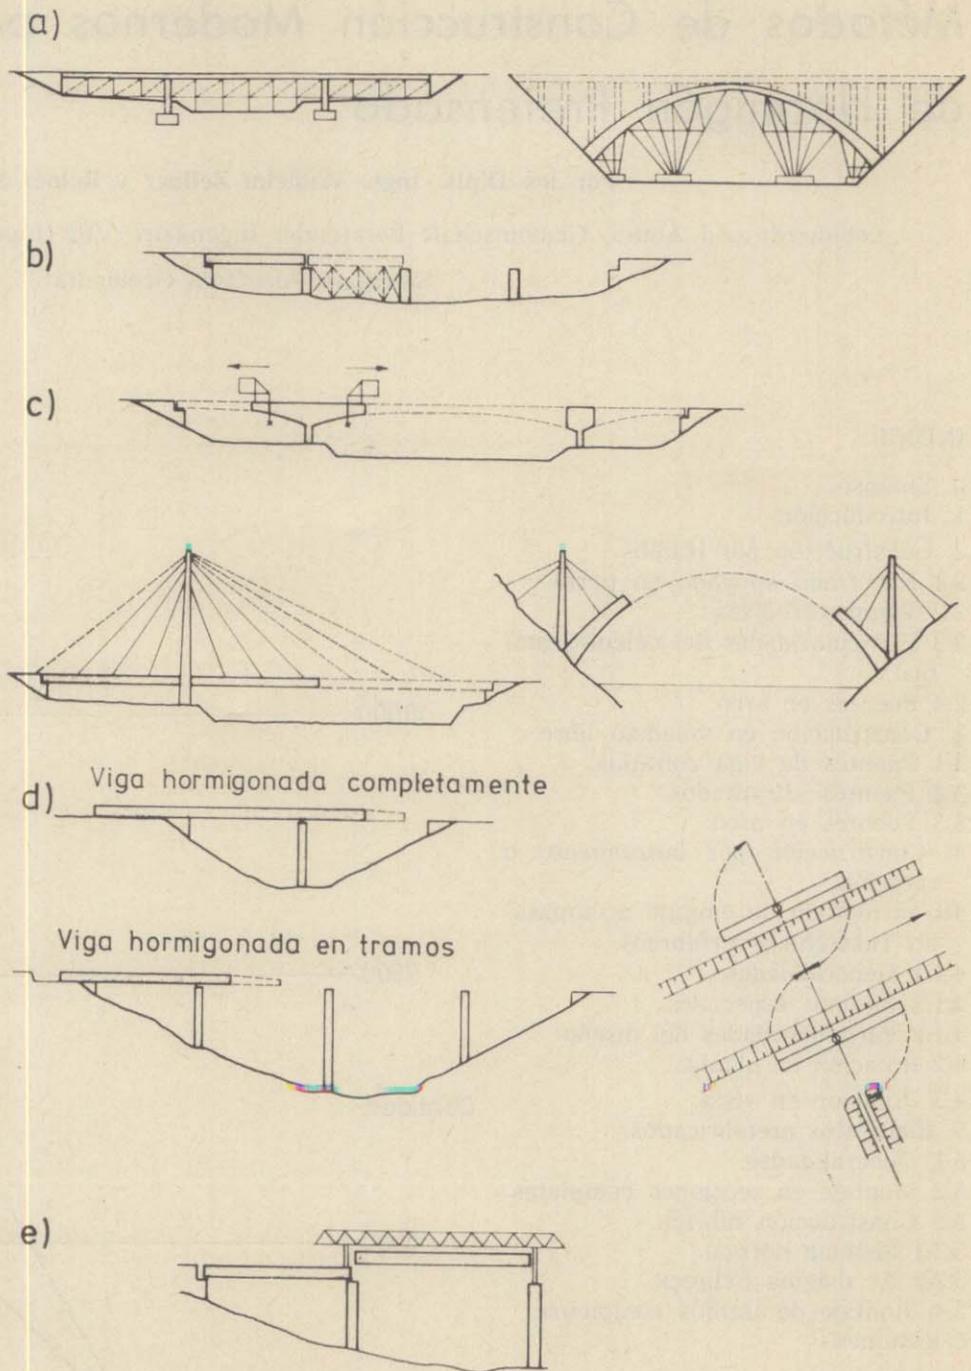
Métodos de construcción para puentes de hormigón pretensado.
